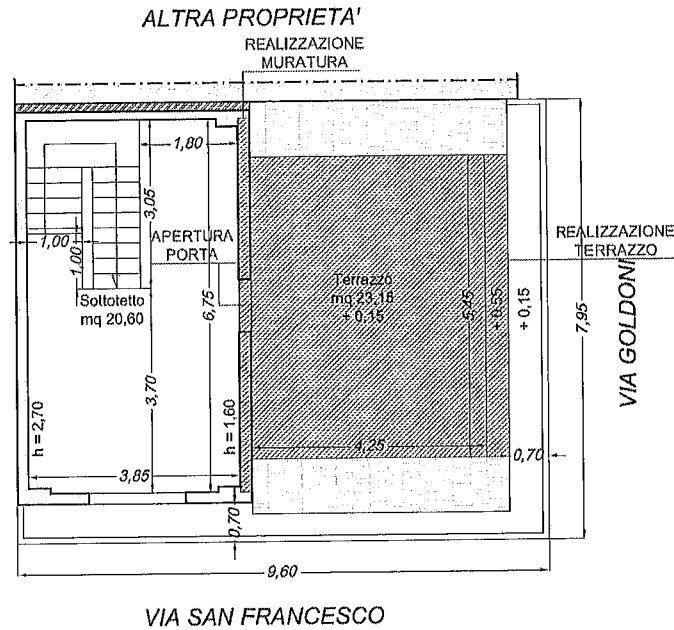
Planimetria Stato di Fatto Piano Sottotetto.
